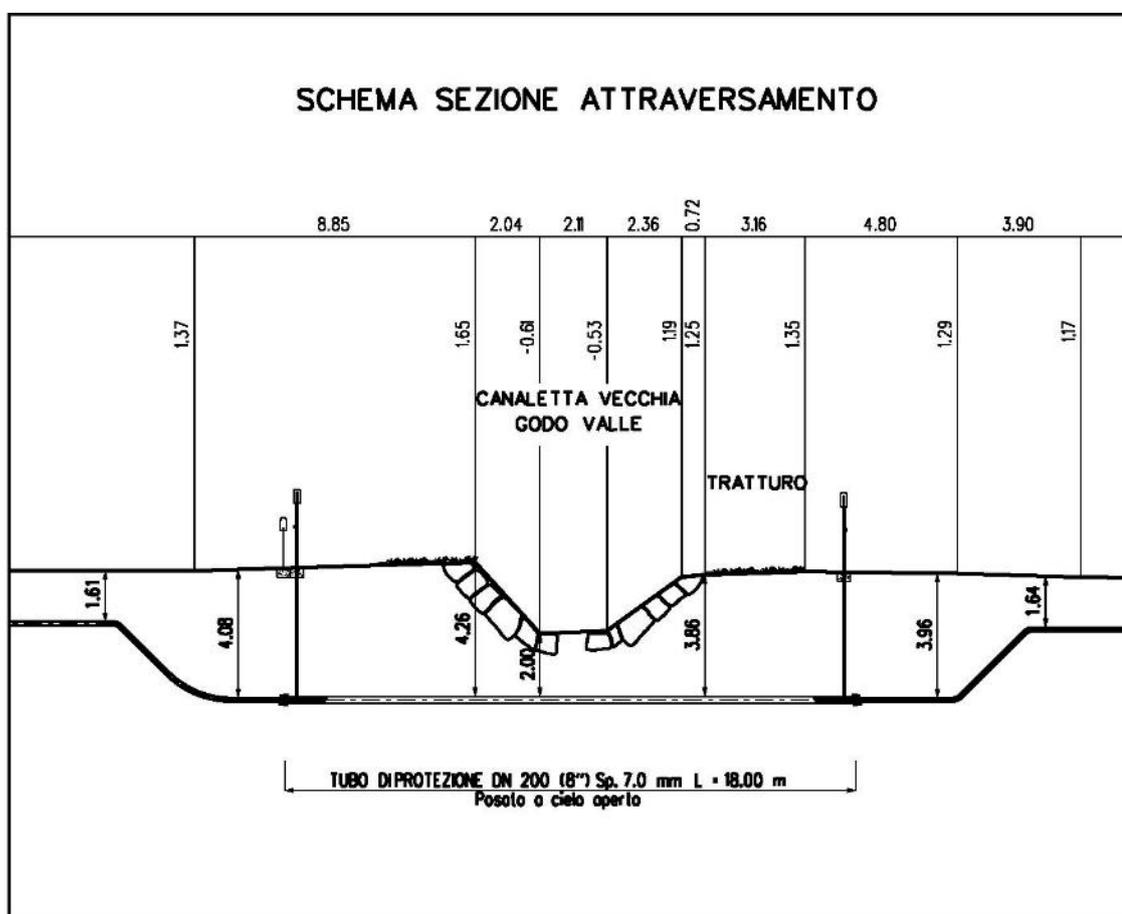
/A – Sezione tipo di attraversamento con posa a cielo aperto
